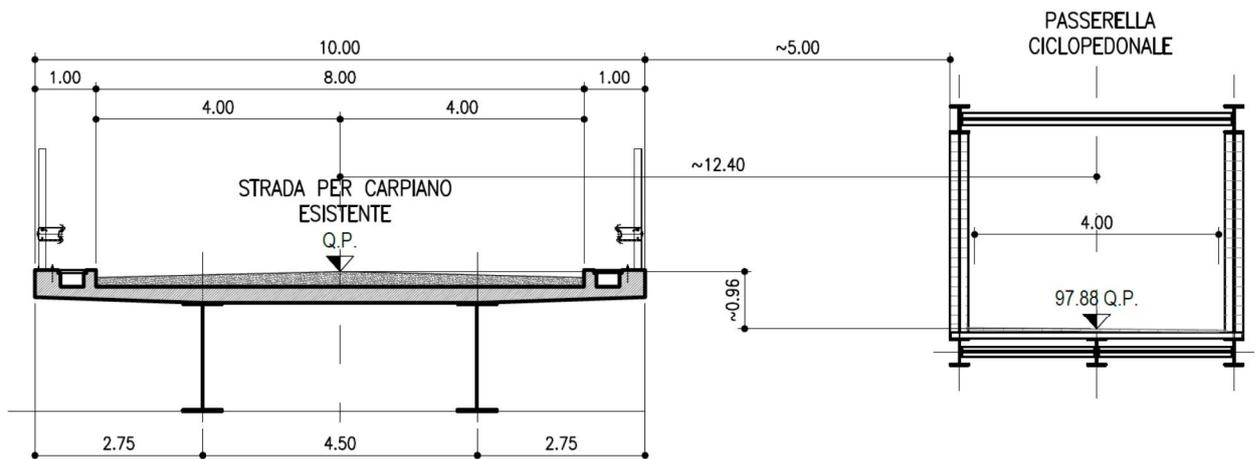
Progetto: sezione trasversale corrente passerella e viadotto adiacente esistente
